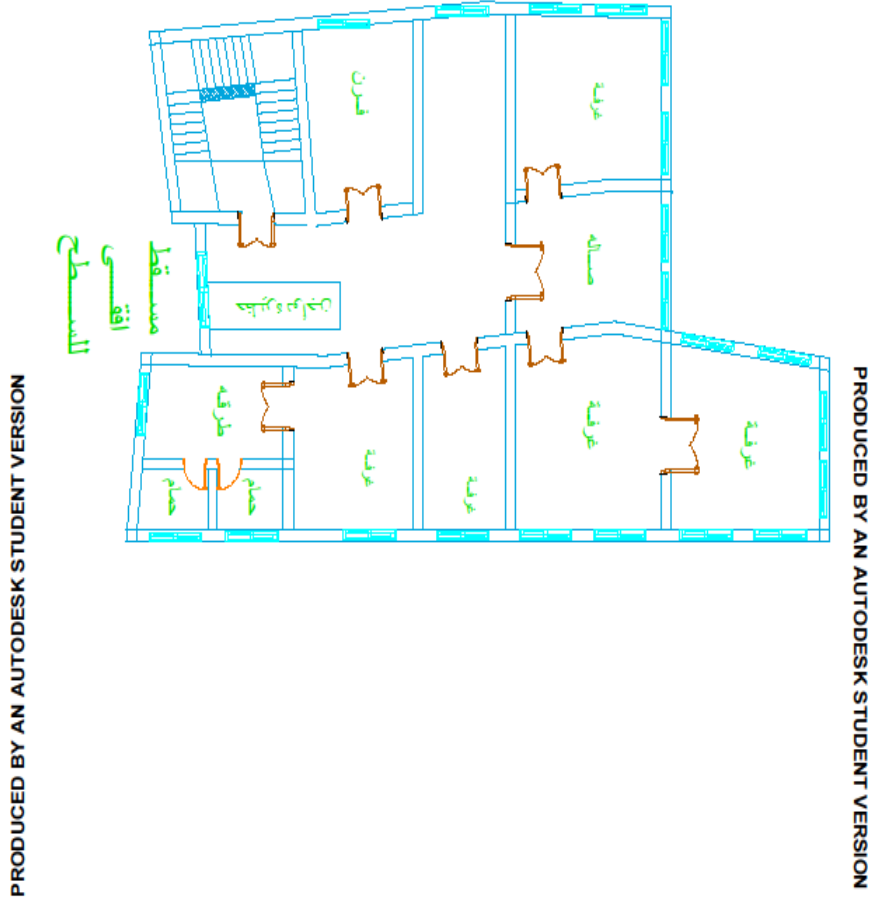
مسقط افقى يوضح مساحة بيت السنجق
